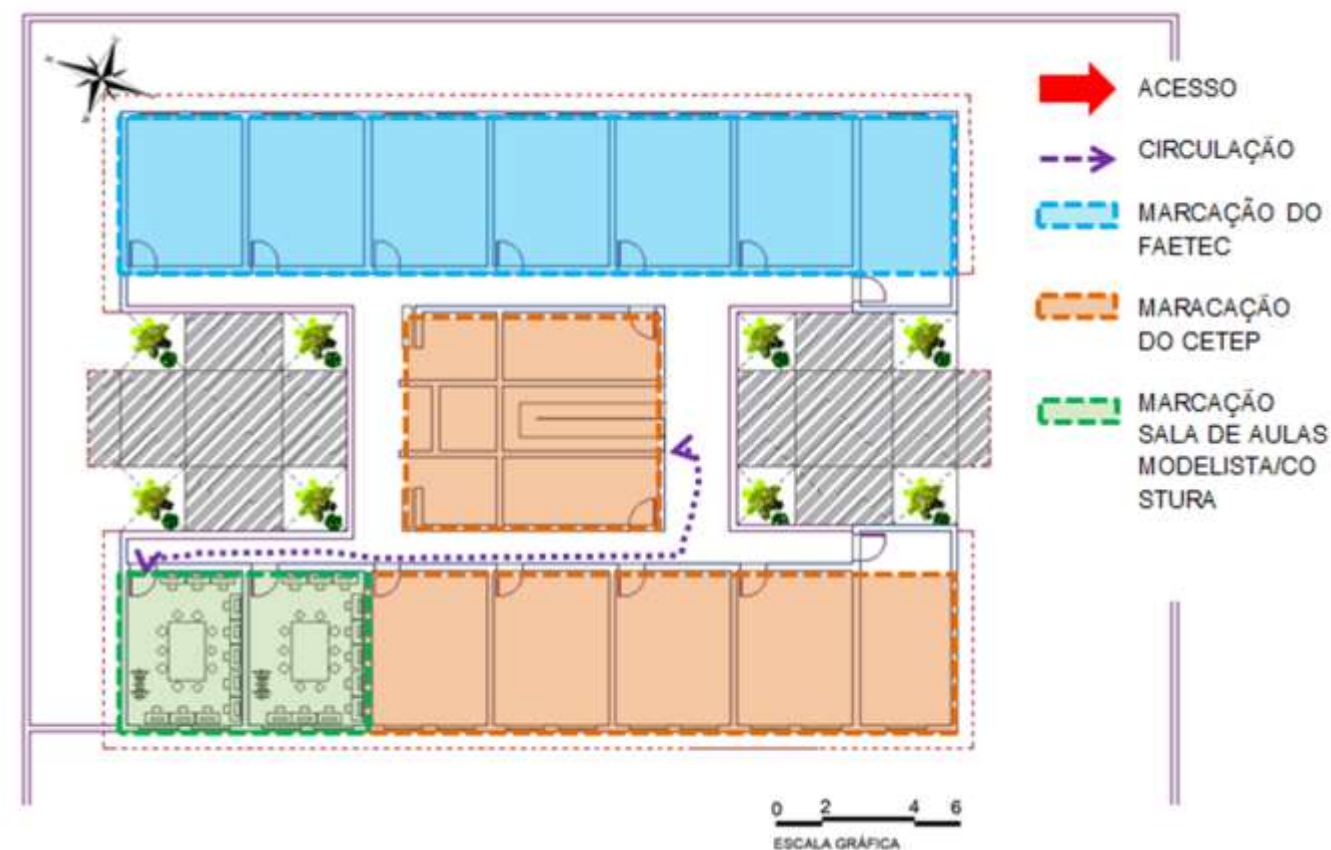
Planta baixa térreo do Colégio Nossa Senhora das Graças.
